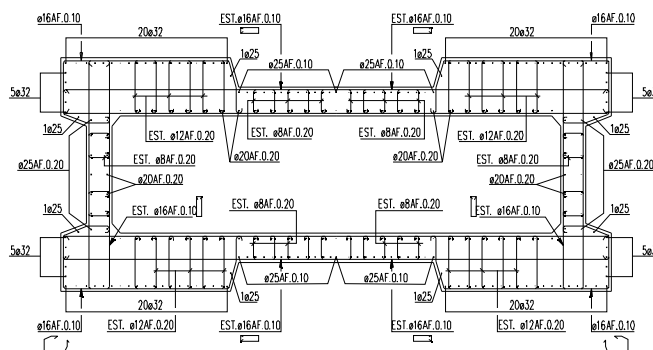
Armadura longitudinal e transversal do pilar P7.
